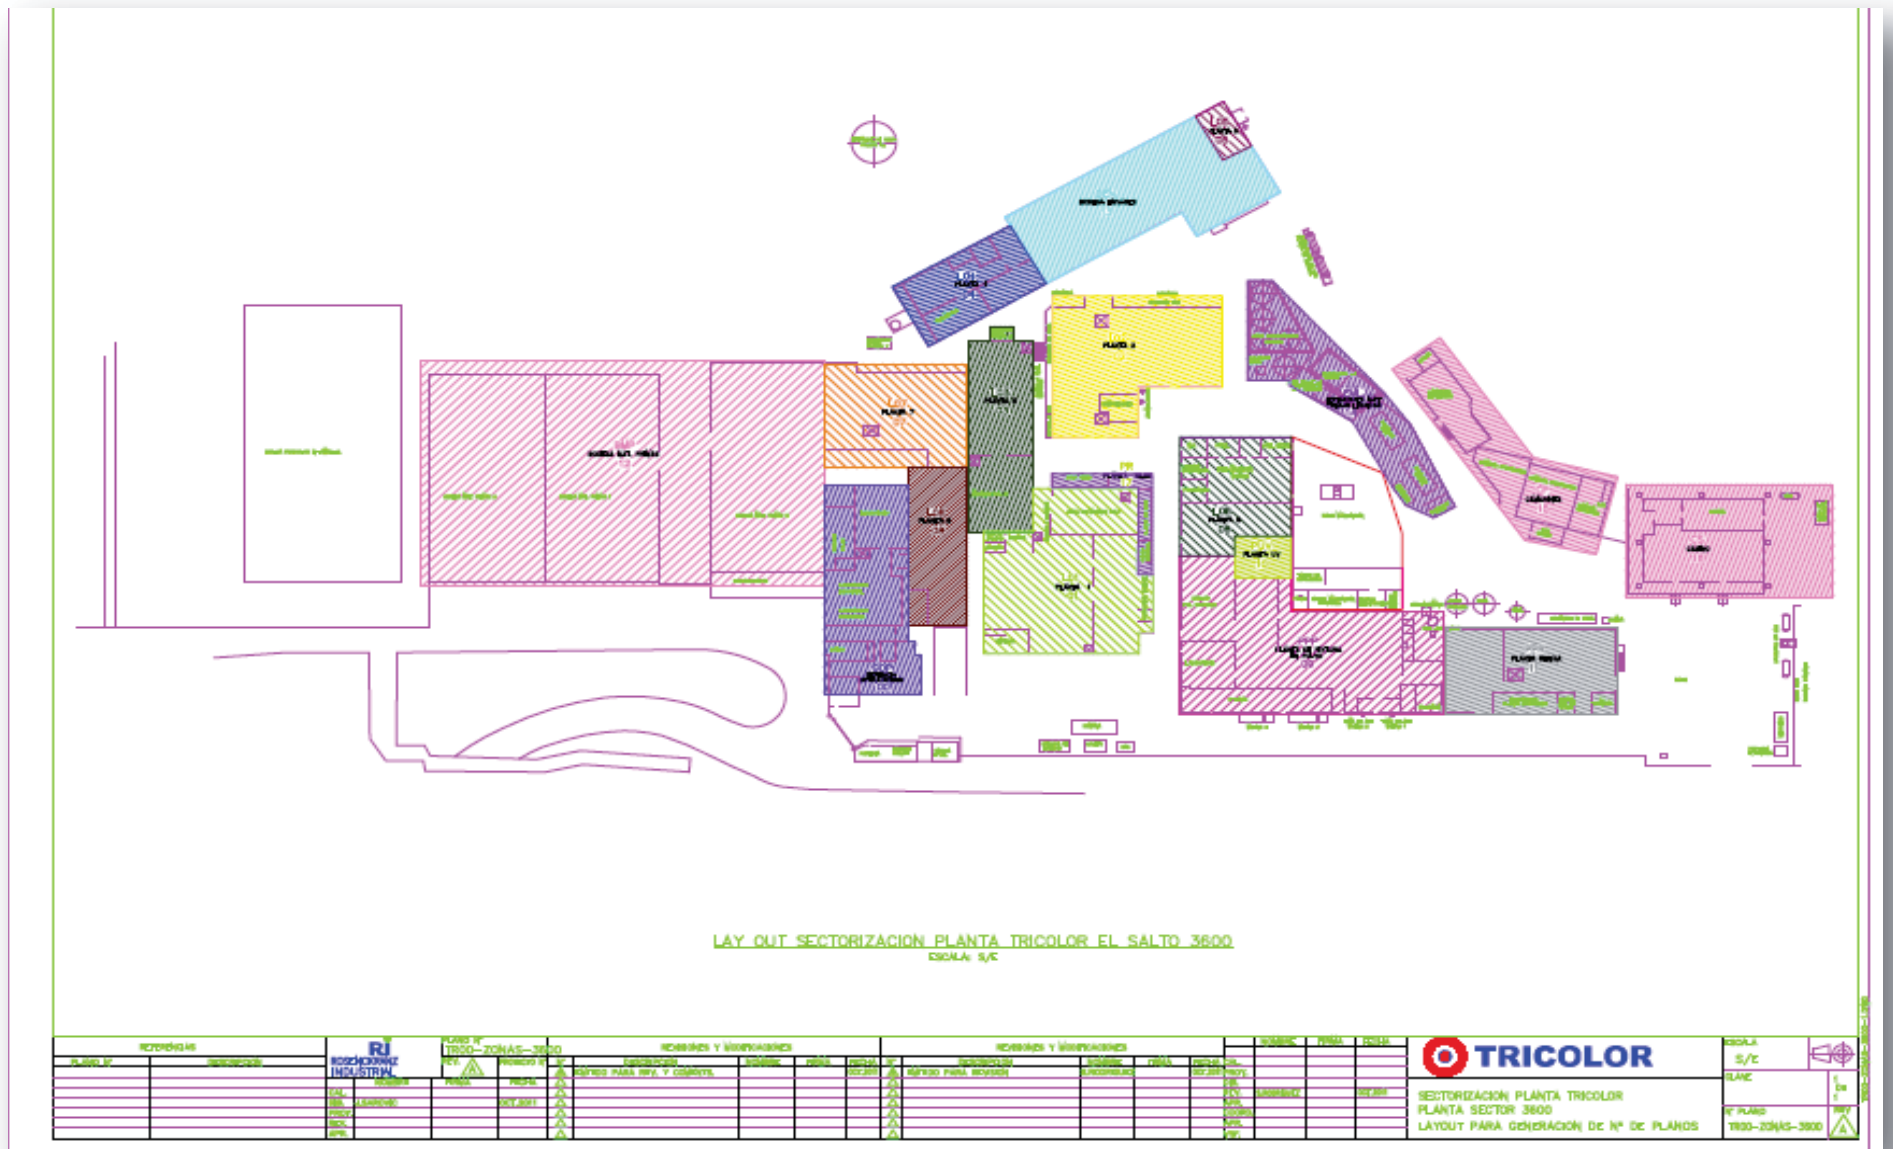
Layout de planta de PINTURAS TRICOLOR S.A. Fuente: TRICOLOR S.A Departamento de Mantenimiento e Ingeniería.
